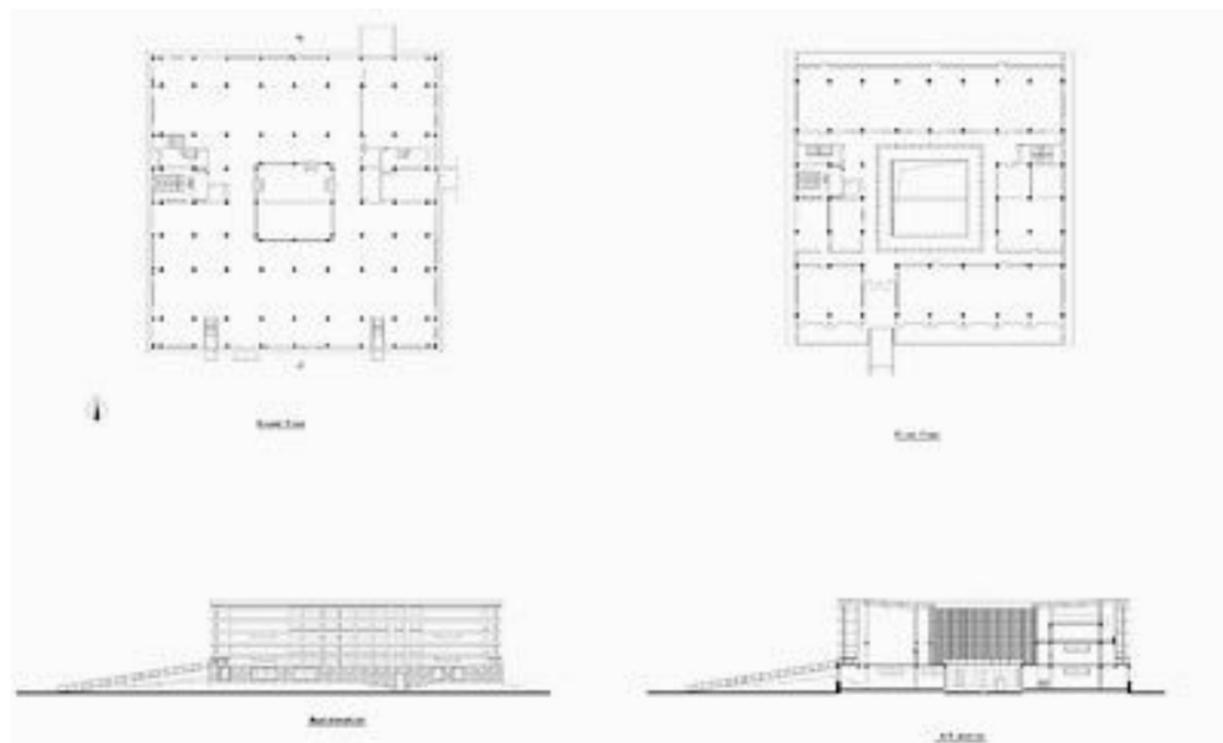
13. Planos del edificio 3: Academia + Talleres. (Imagen extraída en red: world-architects.com).
